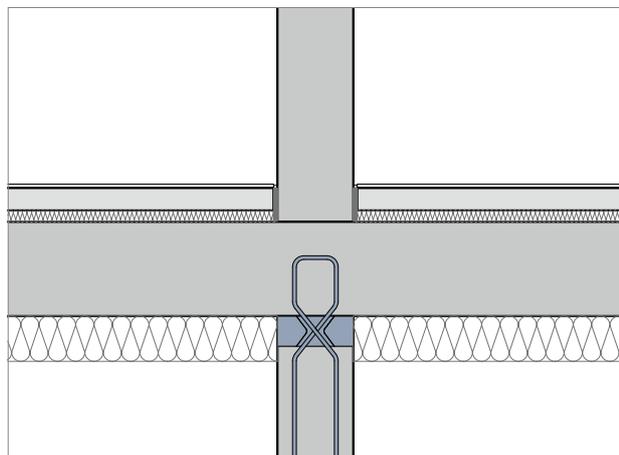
Schöck Sconnex® type W pour mur intérieur et isolation sous la dalle
